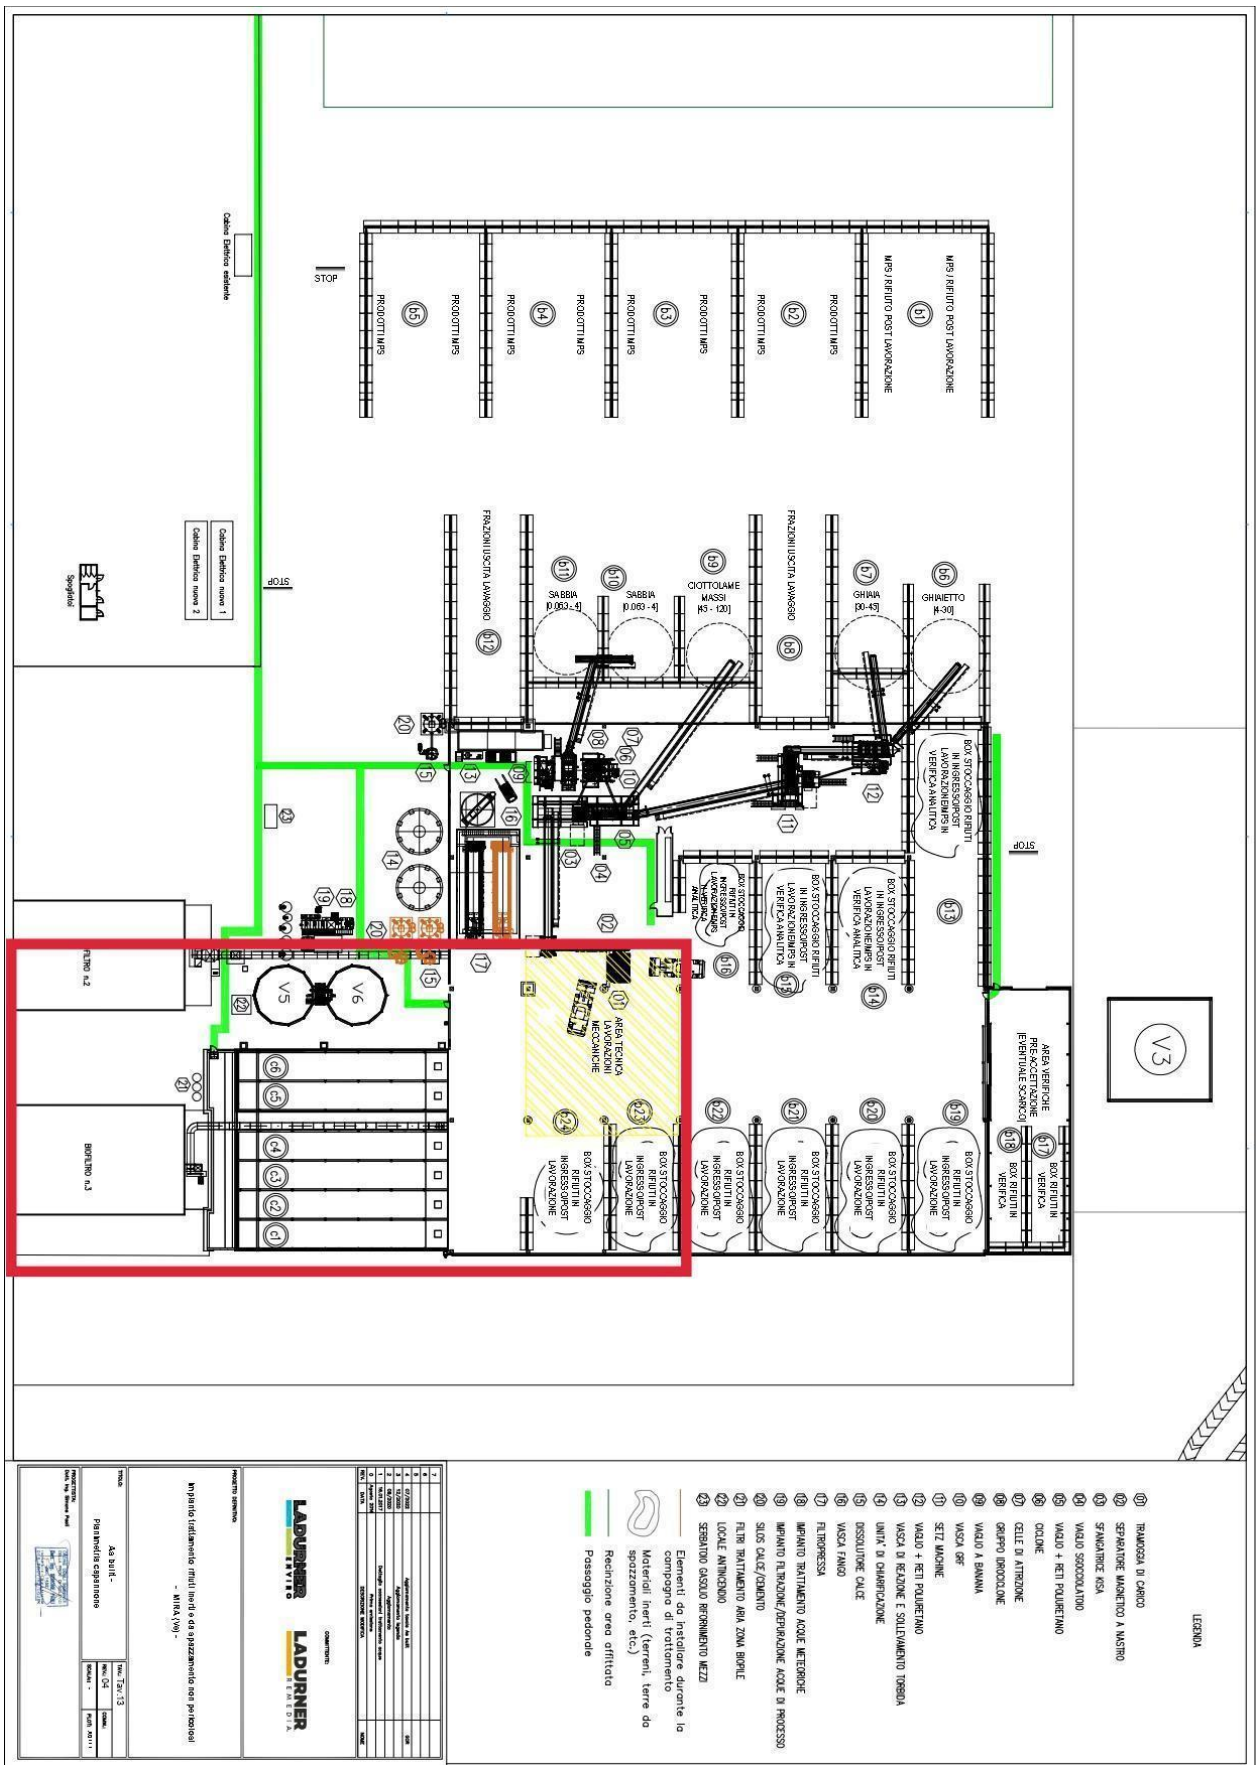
Planimetria dell'impianto di Ladurner Remedia con focus (rettangolo rosso) sulla zona adibita al trattamento in biopile.
